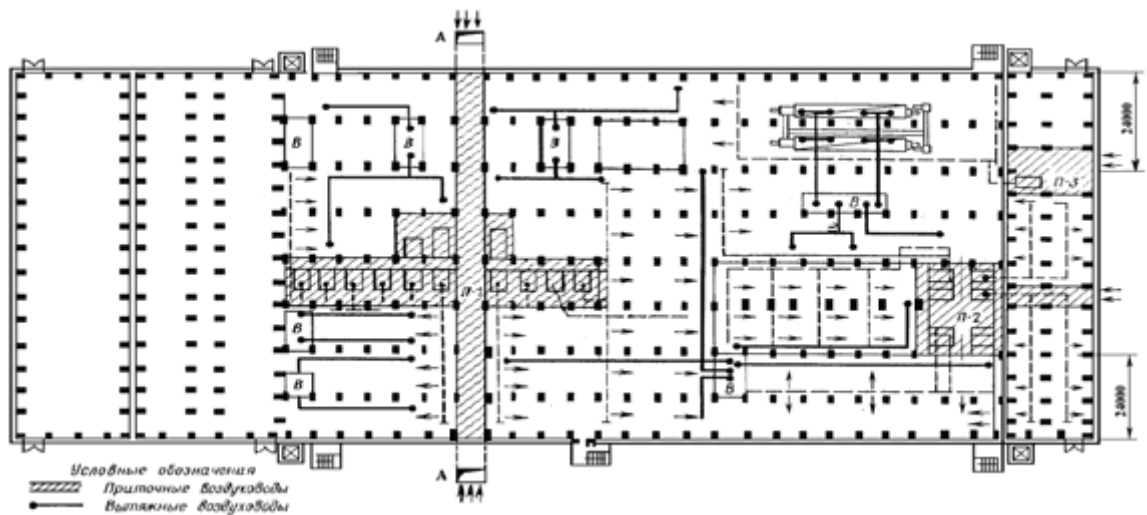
Схема расположения установок общеобменной вентиляции в двухэтажном здании литейного цеха: П-1 – приточная камера обслуживает помещения первого этажа и формовочно-заливочное отделение, размещенное на втором этаже. К камере воздух подается через отдельно стоящие воздухозаборные шахты и подпольные каналы; П-2 – приточная камера для смесеприготовительного и грунтовочного отделений; П-3 – приточная камера для термообрубного отделения; В – вытяжные камеры с системами очистки воздуха и выбросом через трубы; А – воздухозаборные шахты
